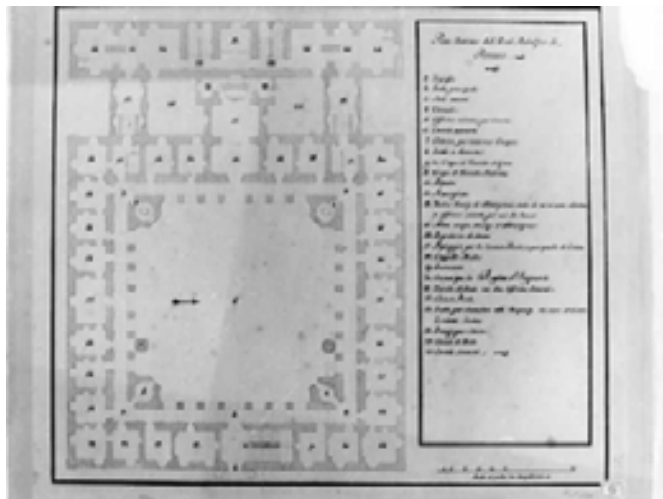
J.D. Piana, *Pianta del piano terreno del Palazzo di Persano
